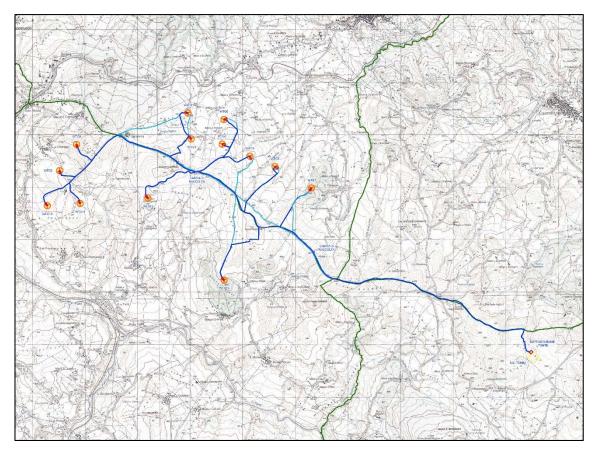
Planimetria generale dell'impianto eolico su cartografia IGM
